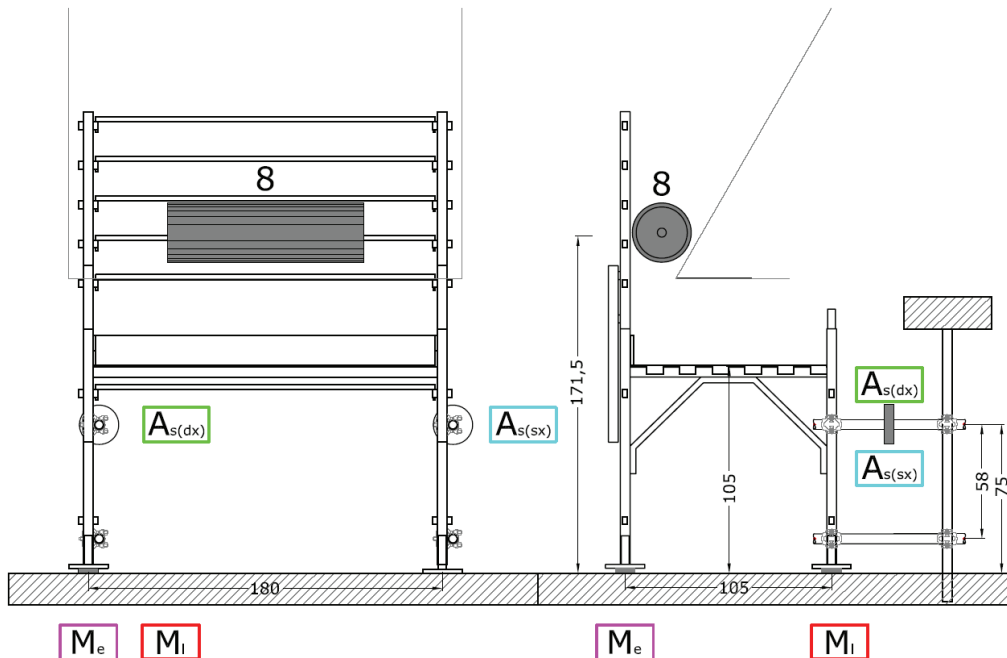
2 Prove d'impatto con rullo cilindrico su corrente intermedio – Schema CS1 – Posizione degli strumenti di misura
